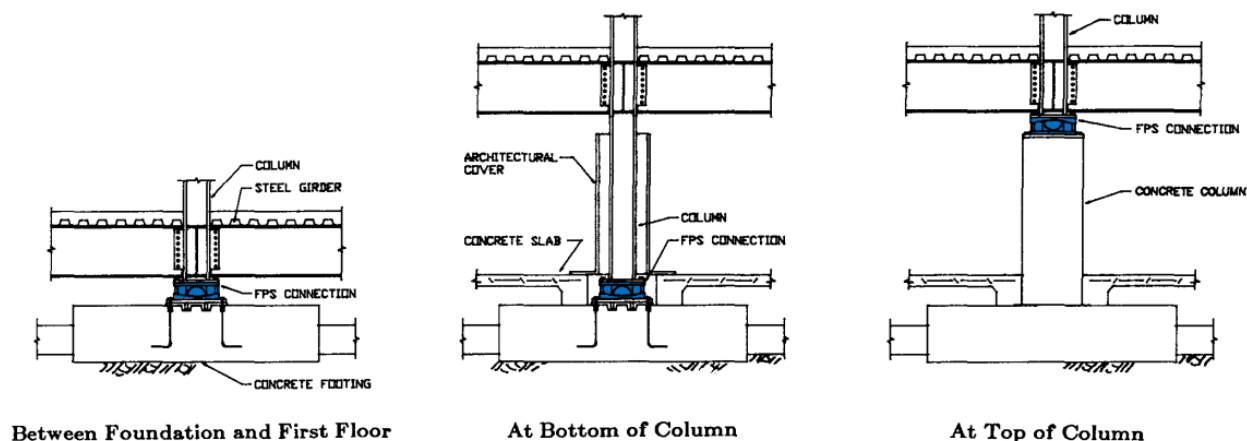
Ubicación de la interfaz de aislación en estructuras con aisladores FPS (Zayas et al., 1990)
